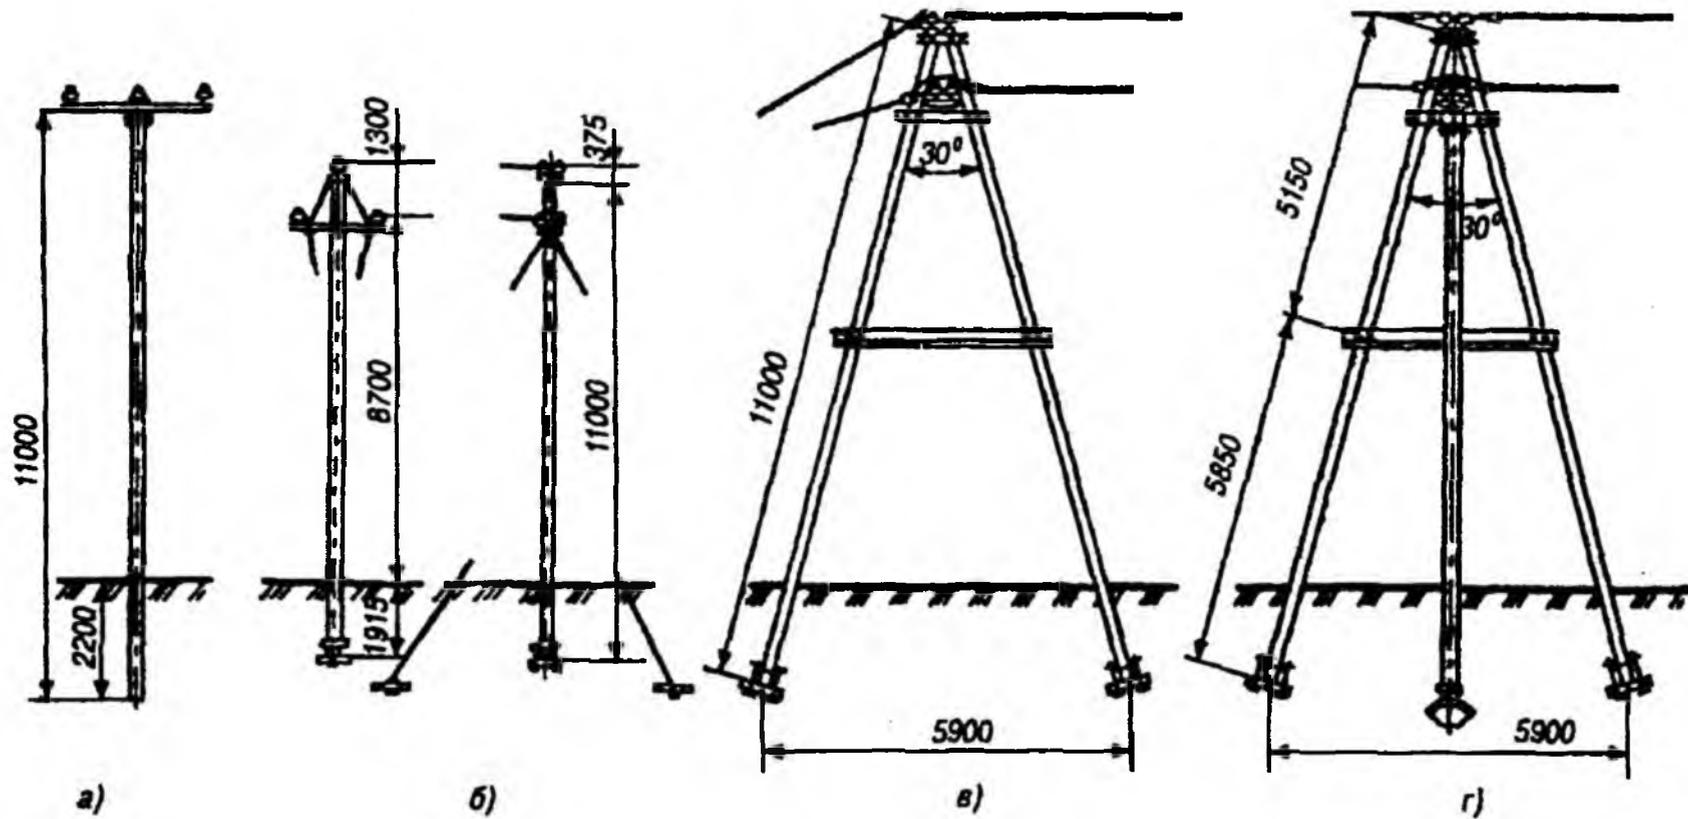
Железобетонные опоры ВЛ6—10 кВ:
